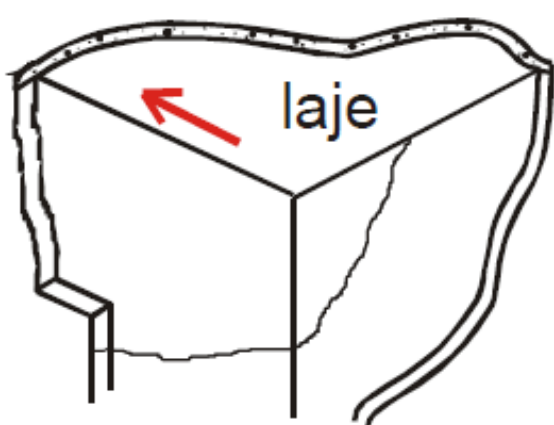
Fissuras em paredes paralelas ao sentido da deformação predominante da laje
